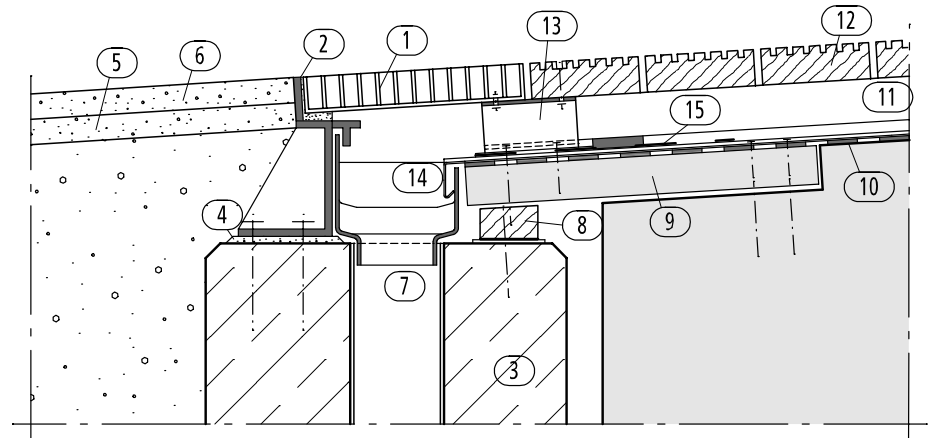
Übergang zu z.B. Seite 6 mit Gitterrost mit Entwässerungsrohr in Widerlagermitte
